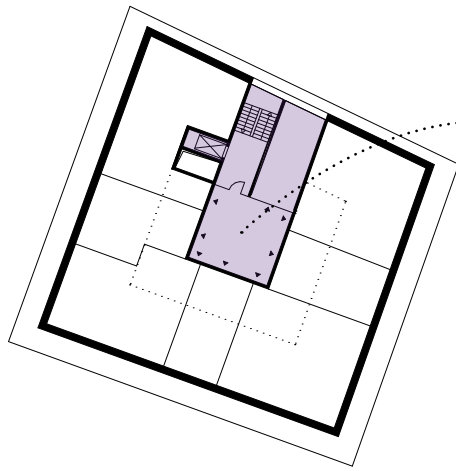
Grundriss Regelgeschoß M 1:500
